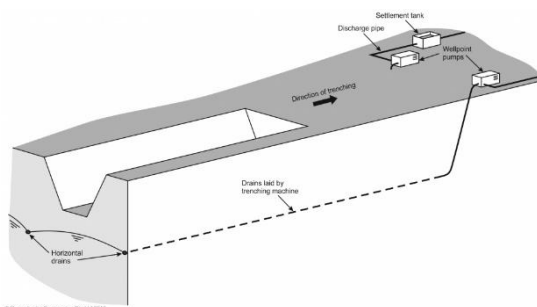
Sistema de poços horizontais (fonte: Groundwater Engineering Pte Ltd [3])
